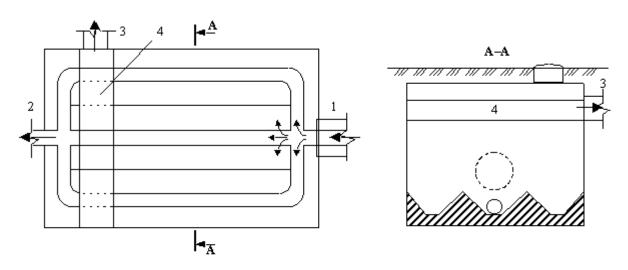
Секционный регулирующий резервуар закрытого типа 1 – подводящий трубопровод; 2 – отводящий трубопровод; 3 – переливной трубопровод; 4 – переливной водослив
